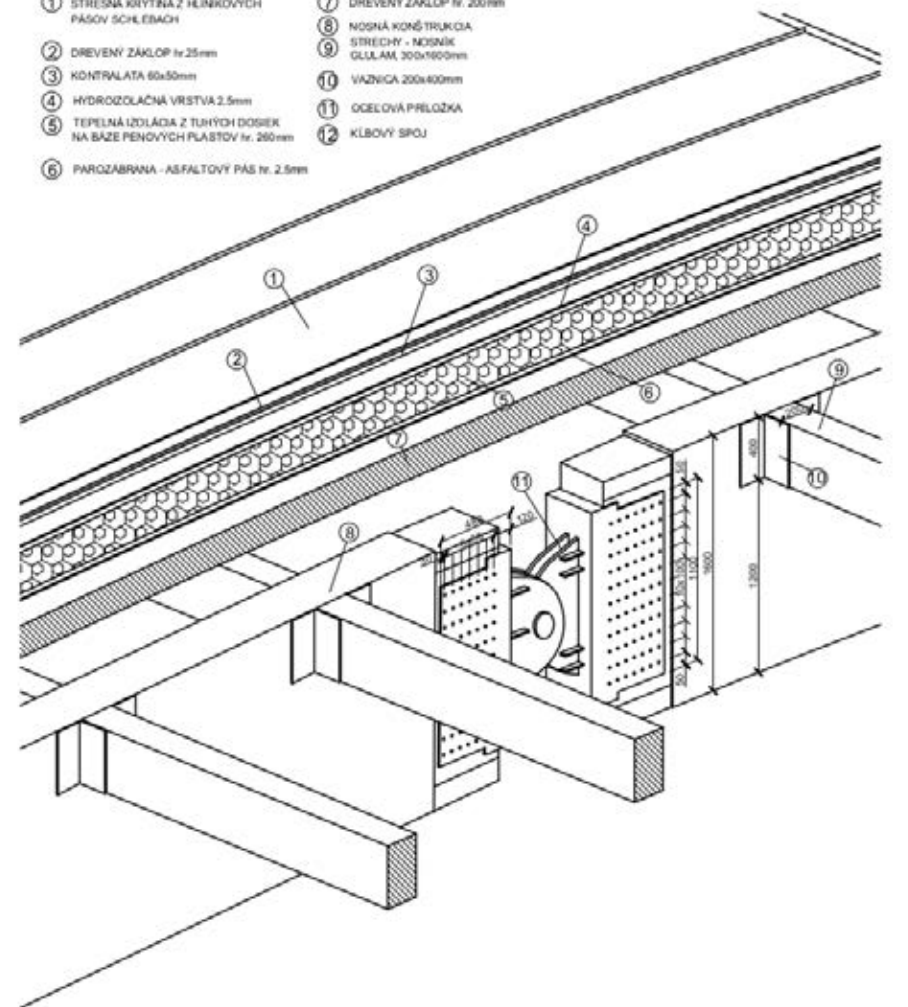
DETAIL STREŠNÉHO PLÁŠŤA "D₅":
